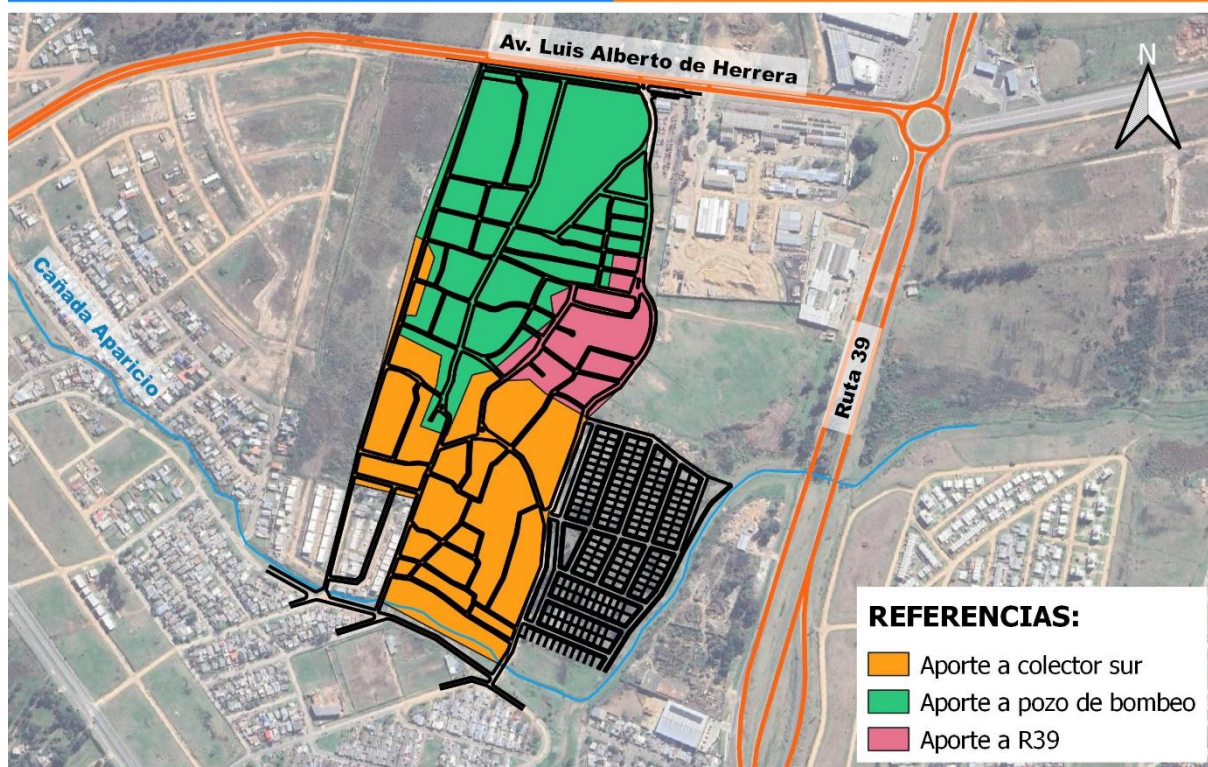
Zonas de aporte a las distintas descargas a saneamiento.
